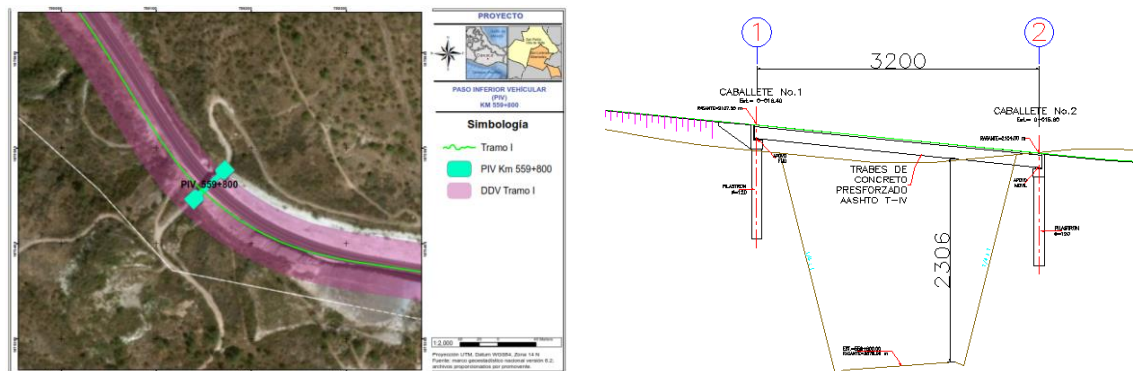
Proyecto en planta y perfil longitudinal del PIV 559+800
